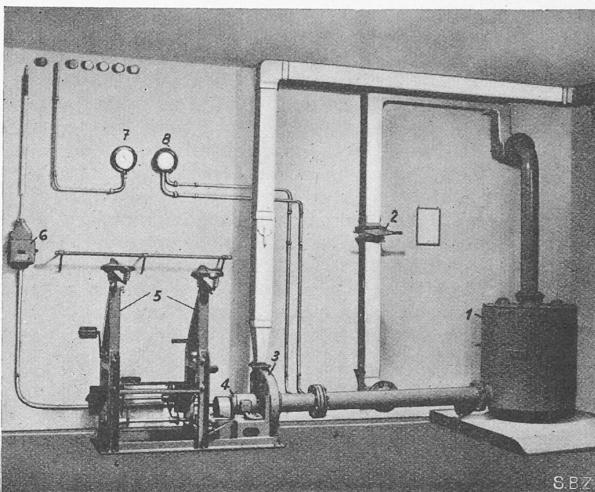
Apparatur in einem Luftschutzraum. — Legende: 1 Gasfilter, 2 Umführung mit gasdichter Klappe, 3 Lüfter, 4 Elektromotor, 5 Notantrieb mittels Tretkurbeln (Veloantrieb), 6 Motorschalter, 7 Ueberdruckmesser, 8 Luftpumpenmesser, 9 Zulufteinführung
